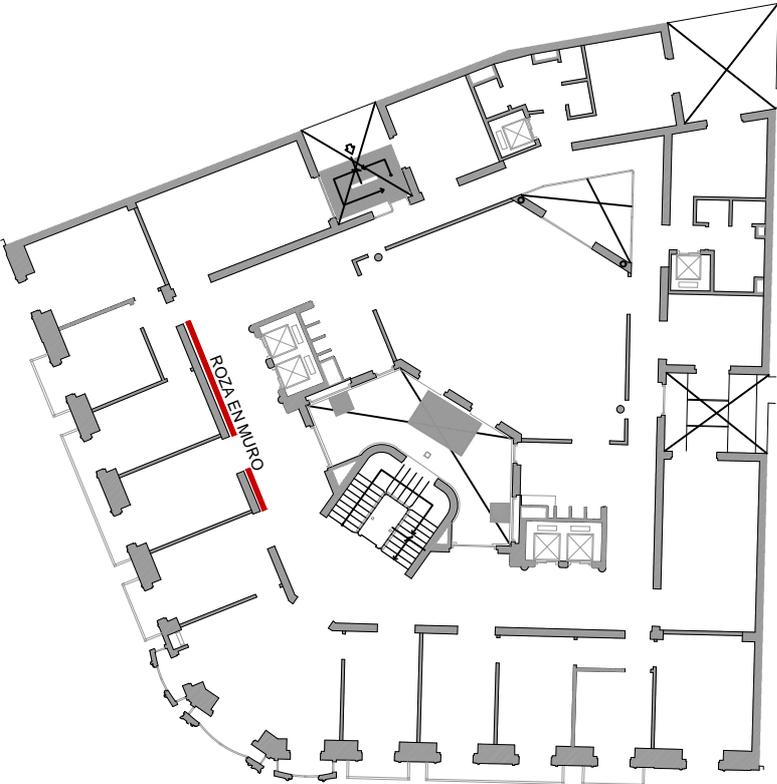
ROZA HORIZONTAL EN MURO DE CARGA DE PLANTA PRIMERA
